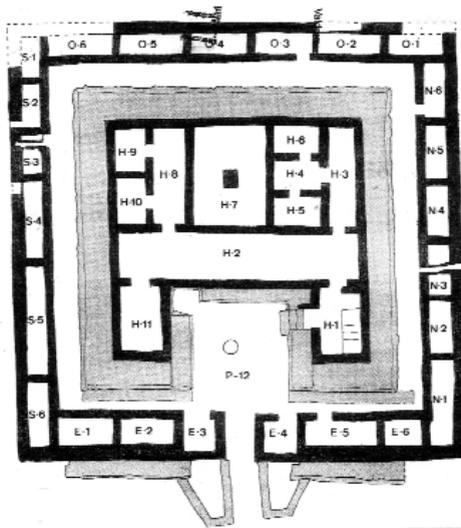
Planta de Cancho Roano. Según S. Celestino.
